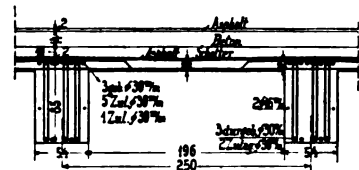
Auflagerquerschnitt der Eindeckung Stiege Rotenturmstraße.
